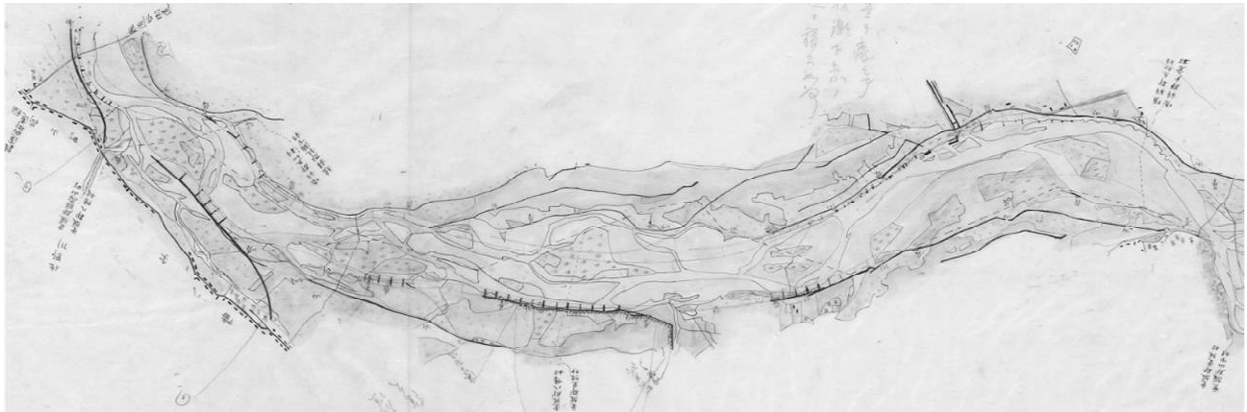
明治26年の千曲川、千曲市付近の状況（千曲川平面図 長測図649）
